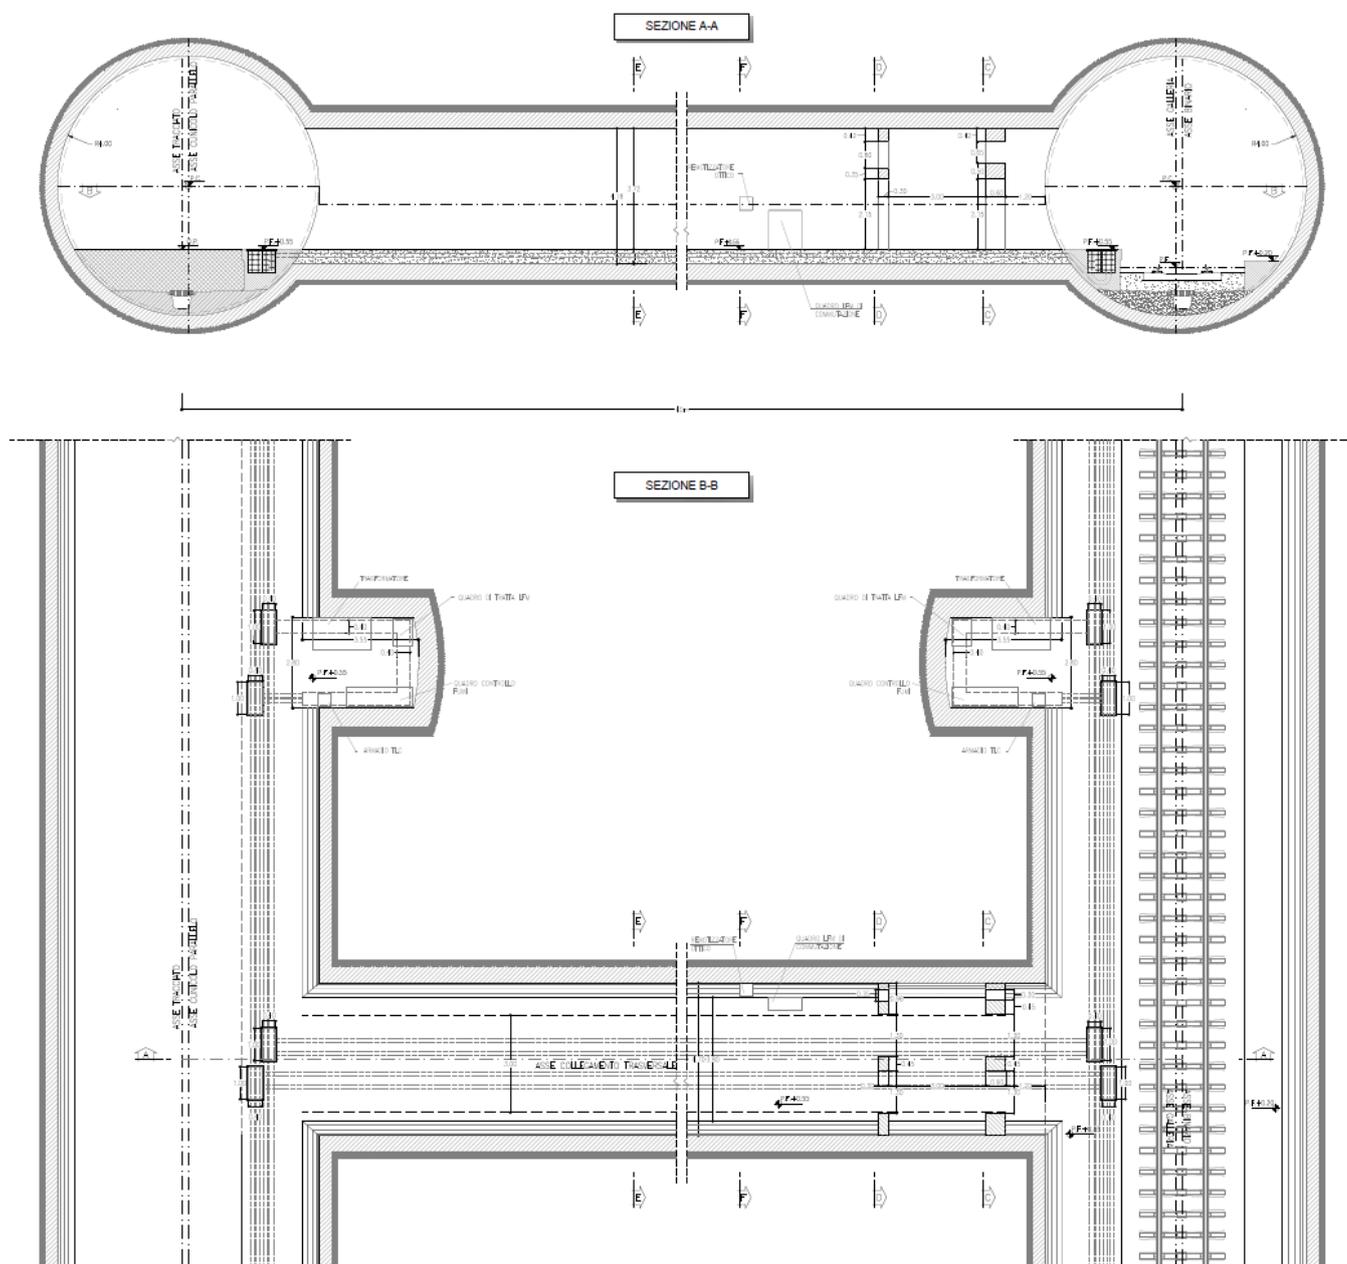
Collegamenti trasversali tra canna ferroviarie e cunicolo – pianta e profilo (scavo meccanizzato)
